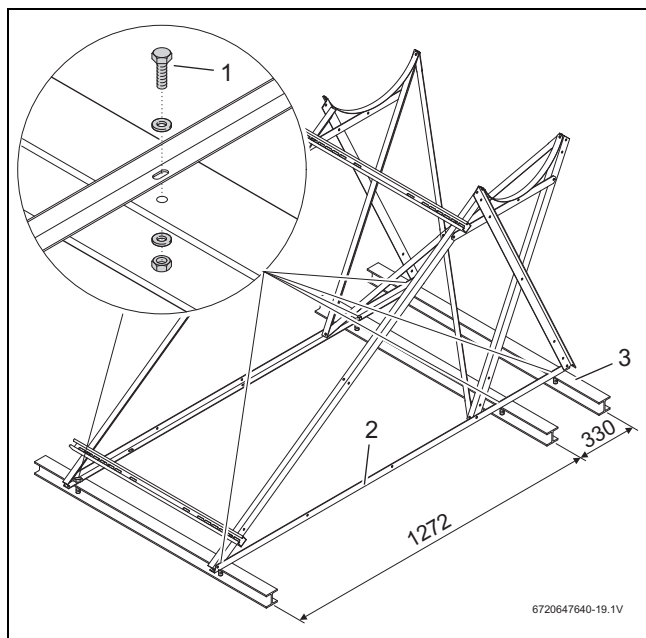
Soporte para tejado plano sobre viga en I, medidas en mm (sistema de 150/200 l)
